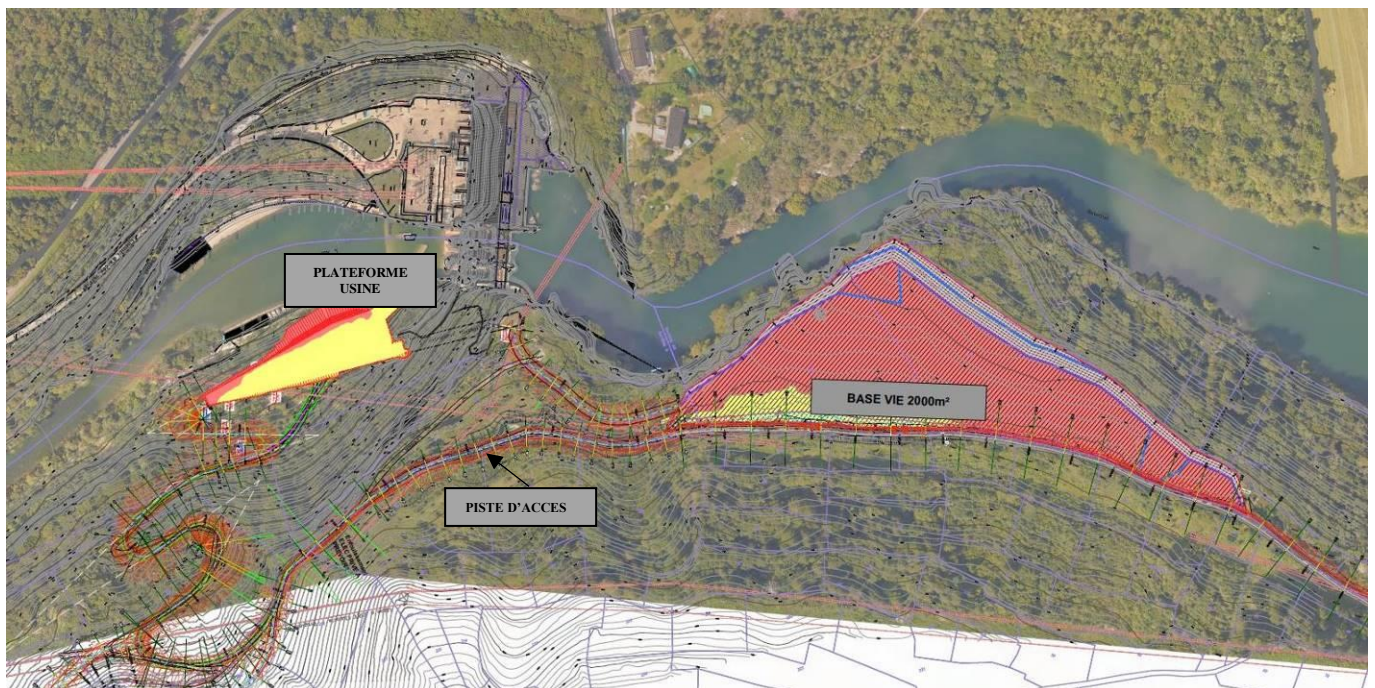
Plan d'ensemble de la zone de chantier et des emprises
